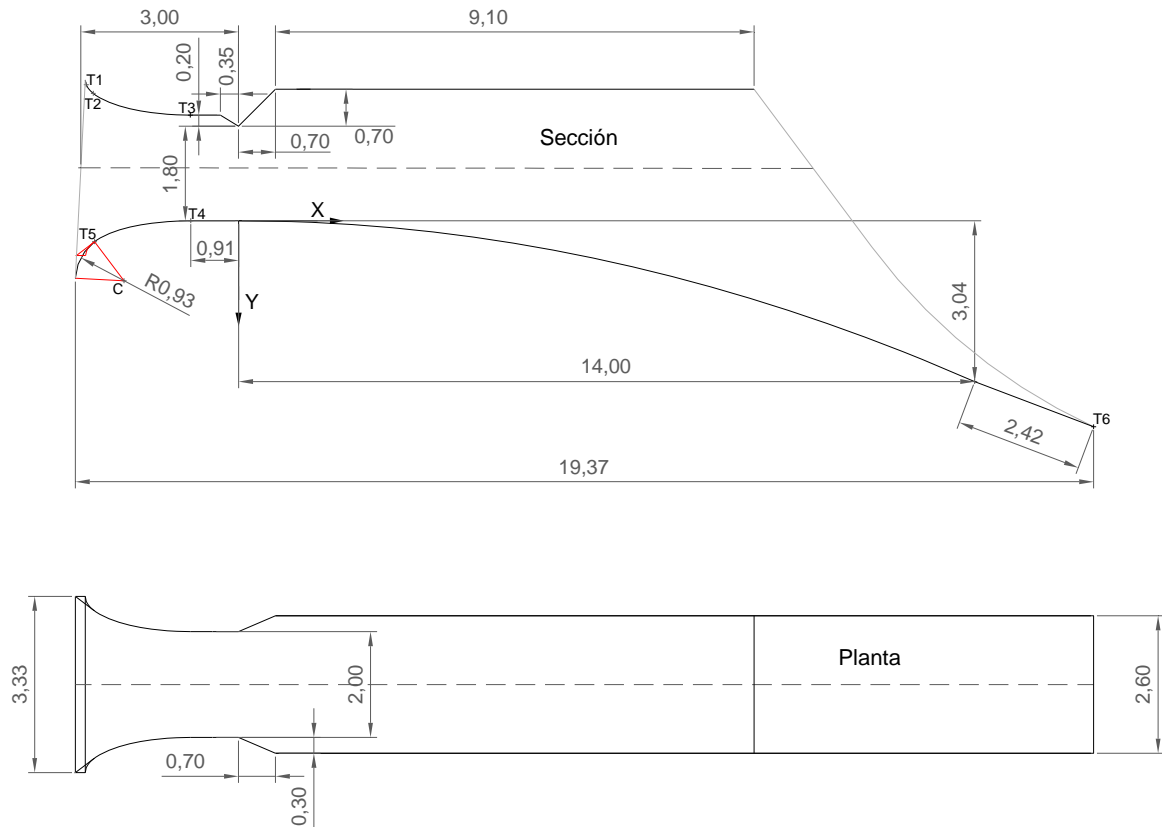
Sección y planta de la nueva geometría del aliviadero A3
